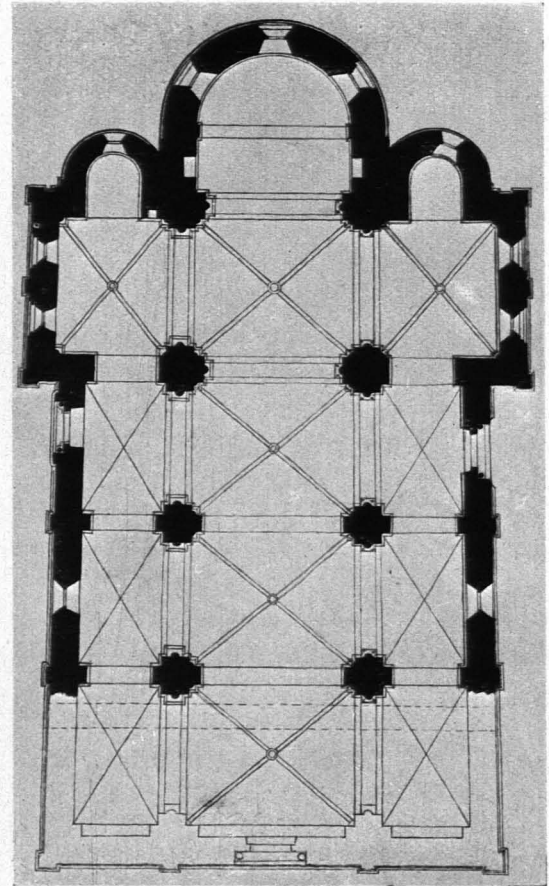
Gelnhausen, St. Peter, Grundriß.
